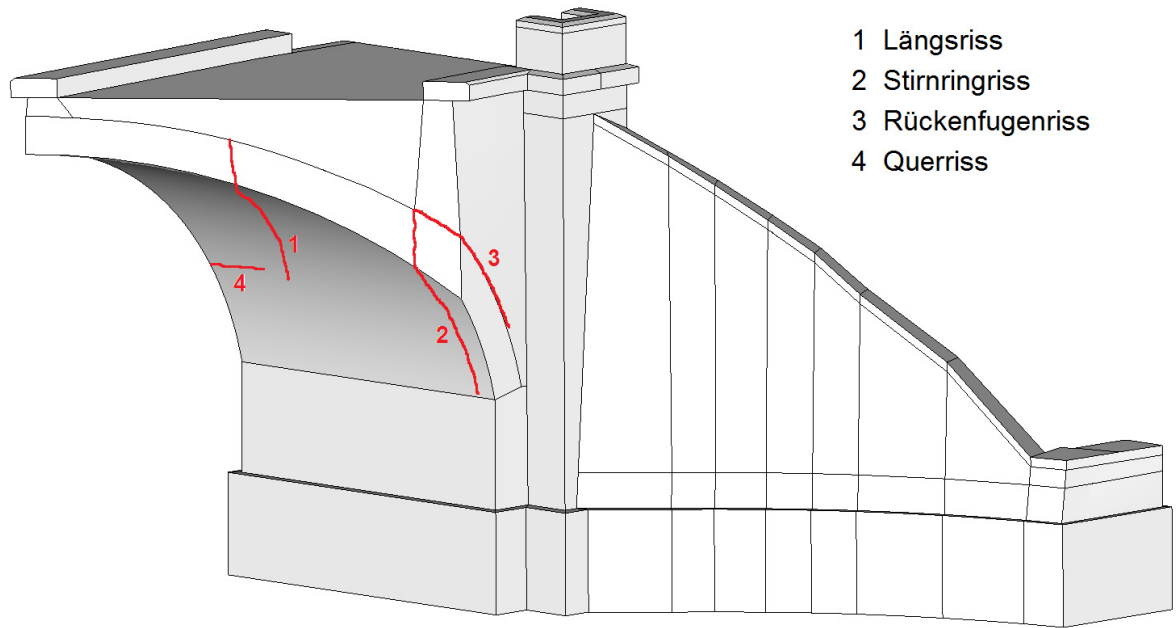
Typische Rissbildungen an Mauerwerksgewölbebrücken
